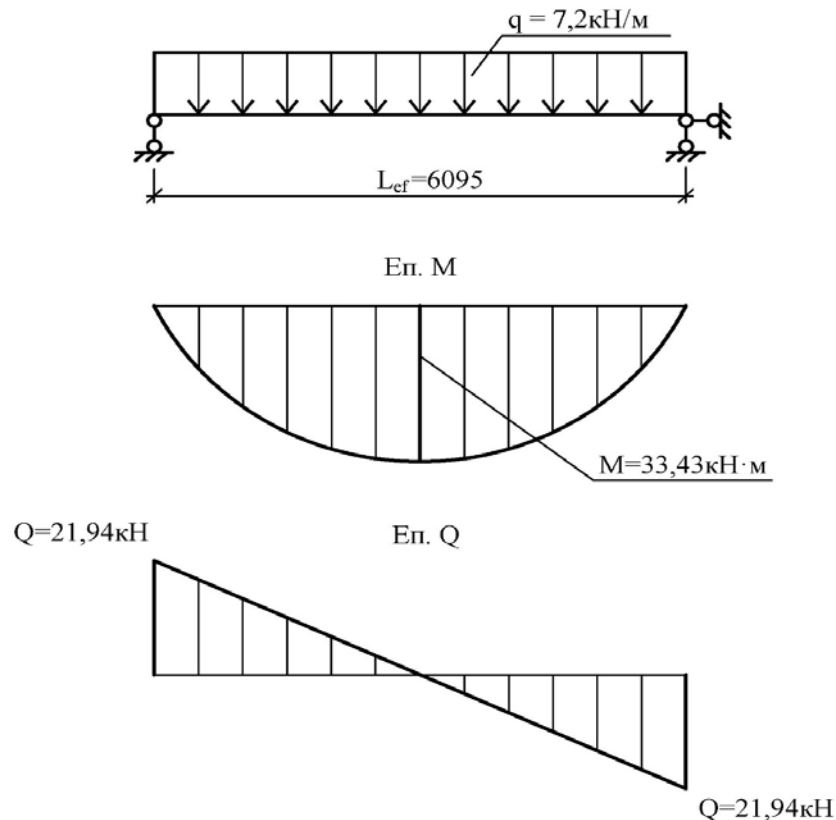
Розрахункова схема та епюри згинальних моментів і поперечних зусиль, що виникають у залізобетонній плиті перекриття [7, 8]
